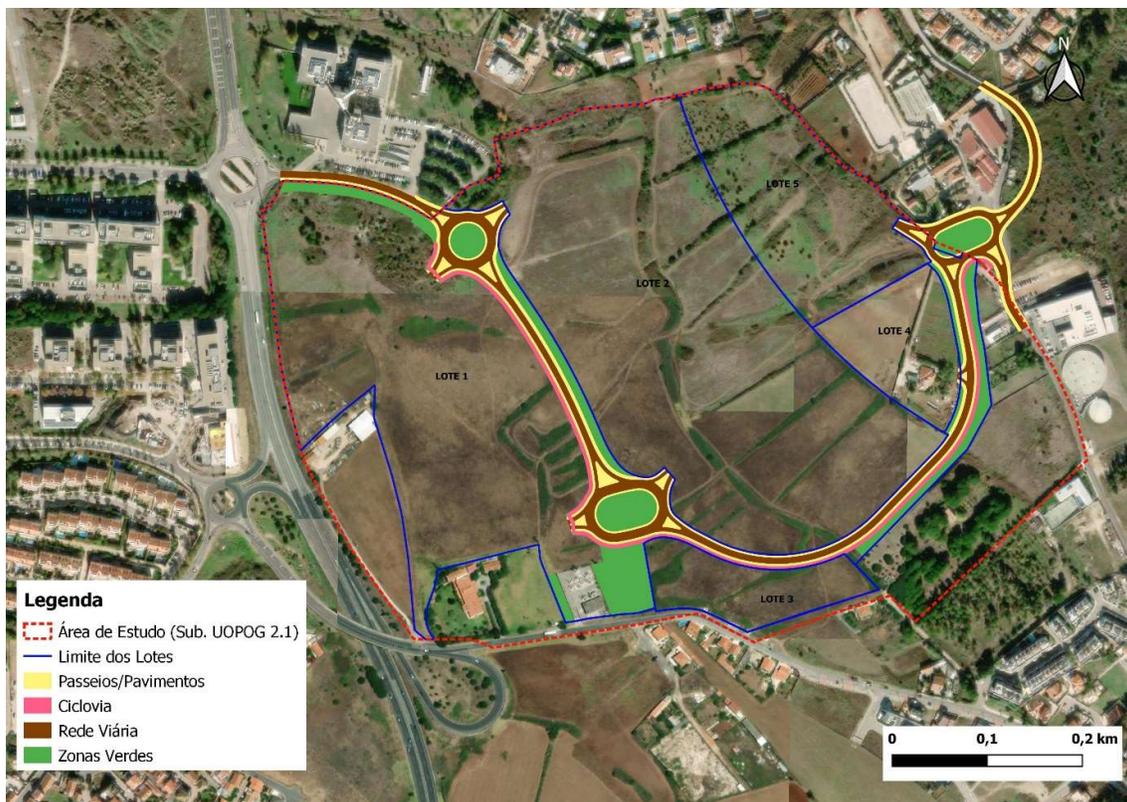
Planta síntese da operação de loteamento da Sub.UOPOG 2.1 do Taguspark – Fase de loteamento
